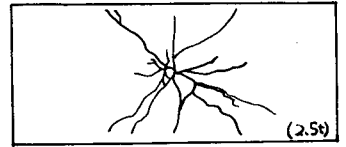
スターラップ使用スラブのひび割れ進行図
